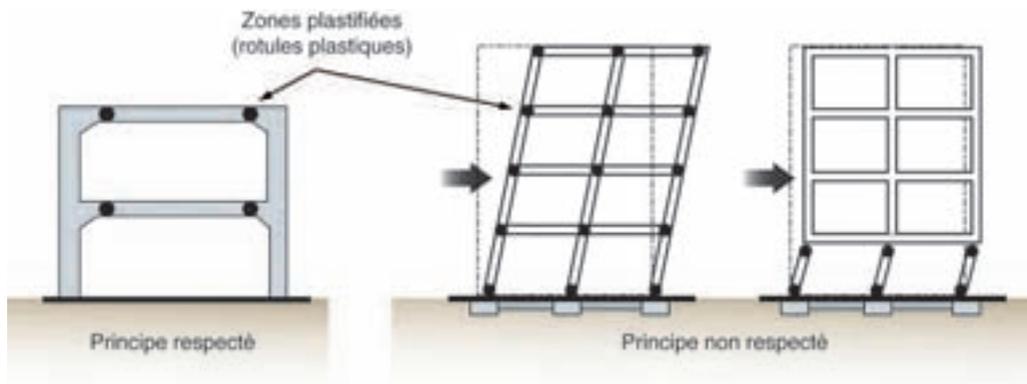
Principe « poteaux forts - poutres faibles ». Le non-respect du principe peut avoir pour conséquence l'effondrement de la structure
